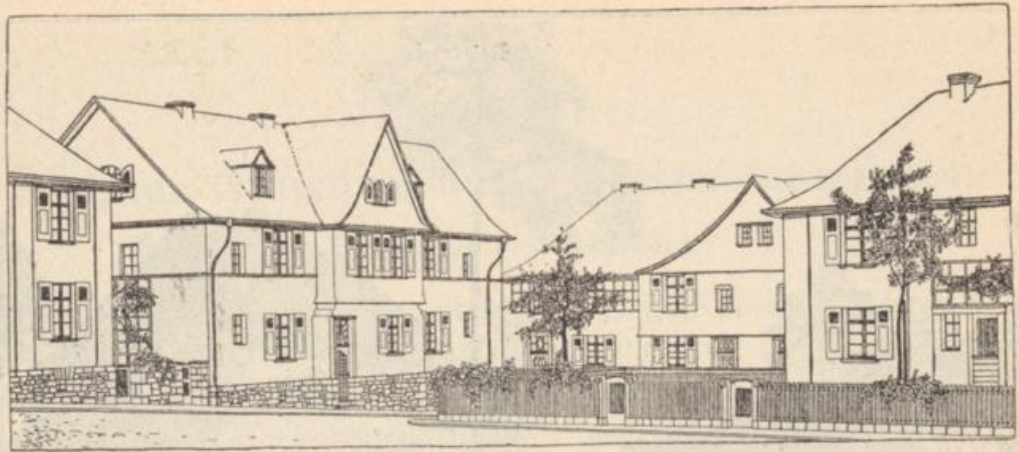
Gartenstadt Hüttenau. Kleinhäusergruppen.
